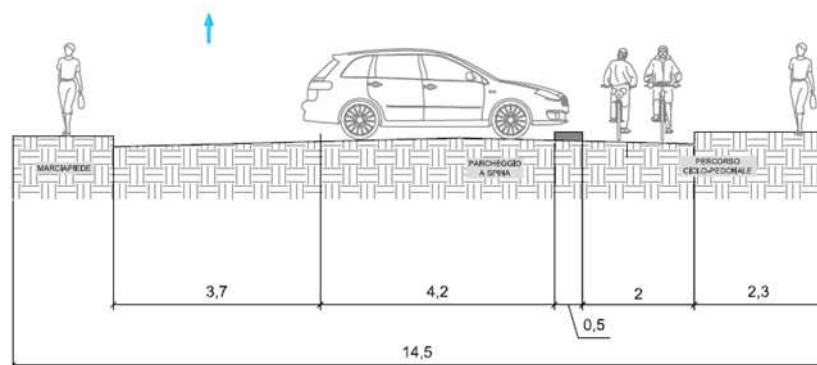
Sezione tipo Via Siena – stato di progetto (2)
